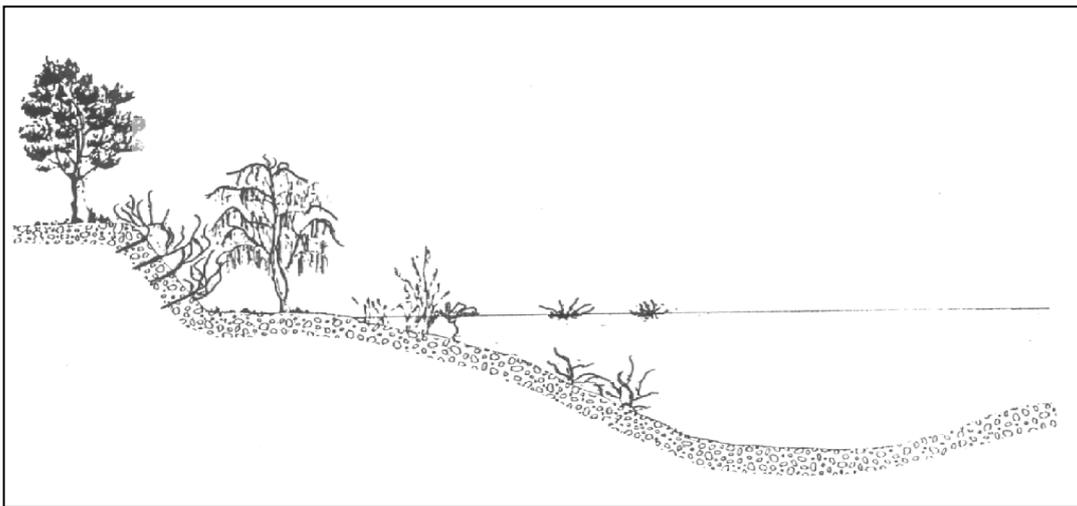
ESEMPIO CARATTERISTICO DELL'INTERVENTO DI RISEZIONAMENTO
